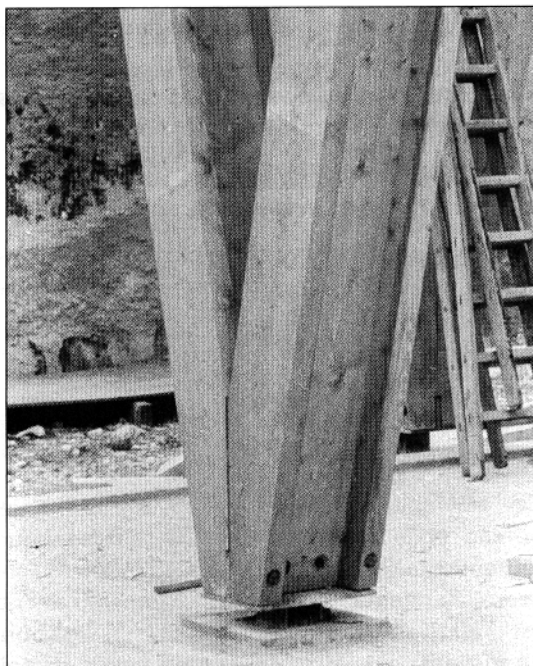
• Ossature bois : liaison par plaque métallique entre le pied de poteau et la fondation.
